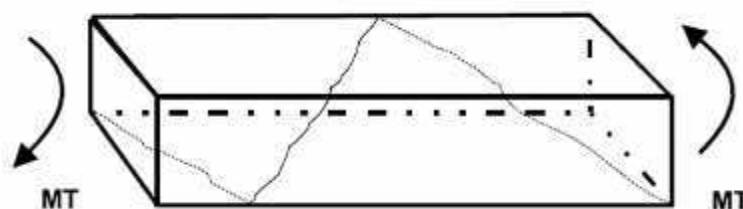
Fissuras ou rupturas por torção, fonte DNER 1994
